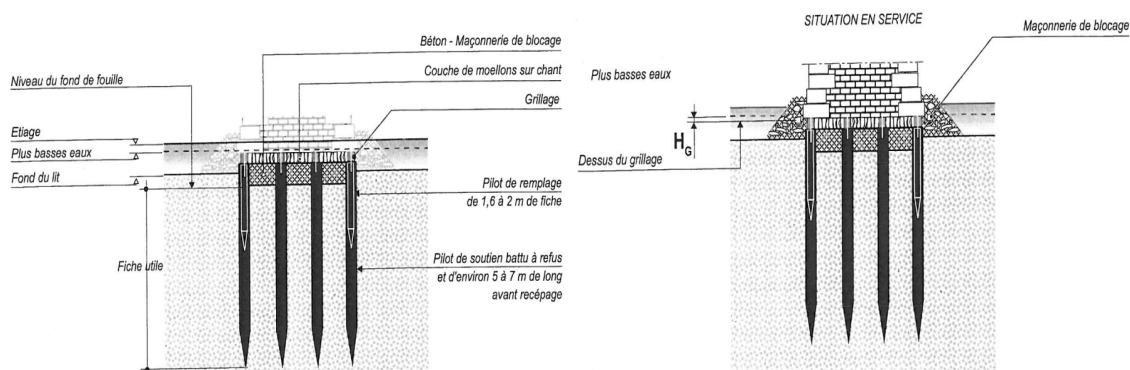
Principe de construction des fondations par Gauthey (Maillard, 2006)
